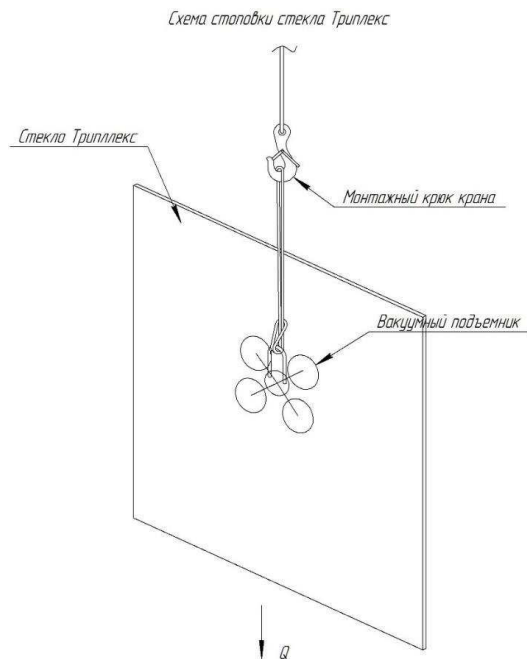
Общий вид вакуумного подъемника и схема строповки стекла
